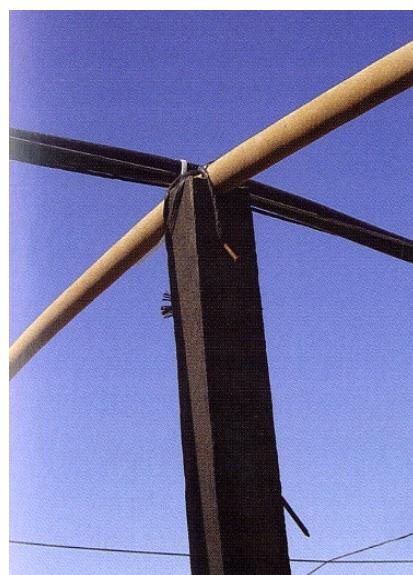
Detalle del pilar interior, con una hendidura para que encaje perfectamente el arco
